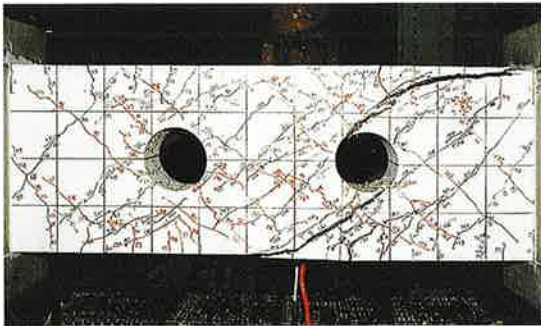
開孔部のひび割れ状況 (破壊時・2開孔)
